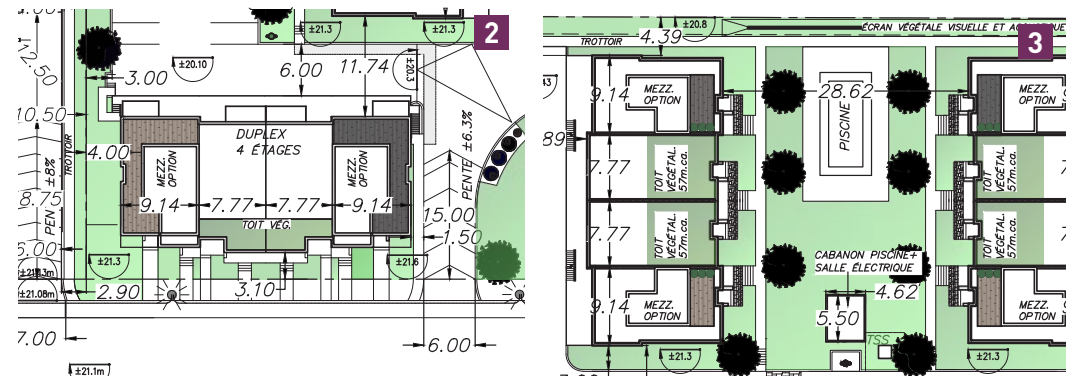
[2] et [3] Extraits du plan d'implantation des Duplex et Triplex du Square Candiac. (Source : PDA Architecture, JMJ Immobilier).
